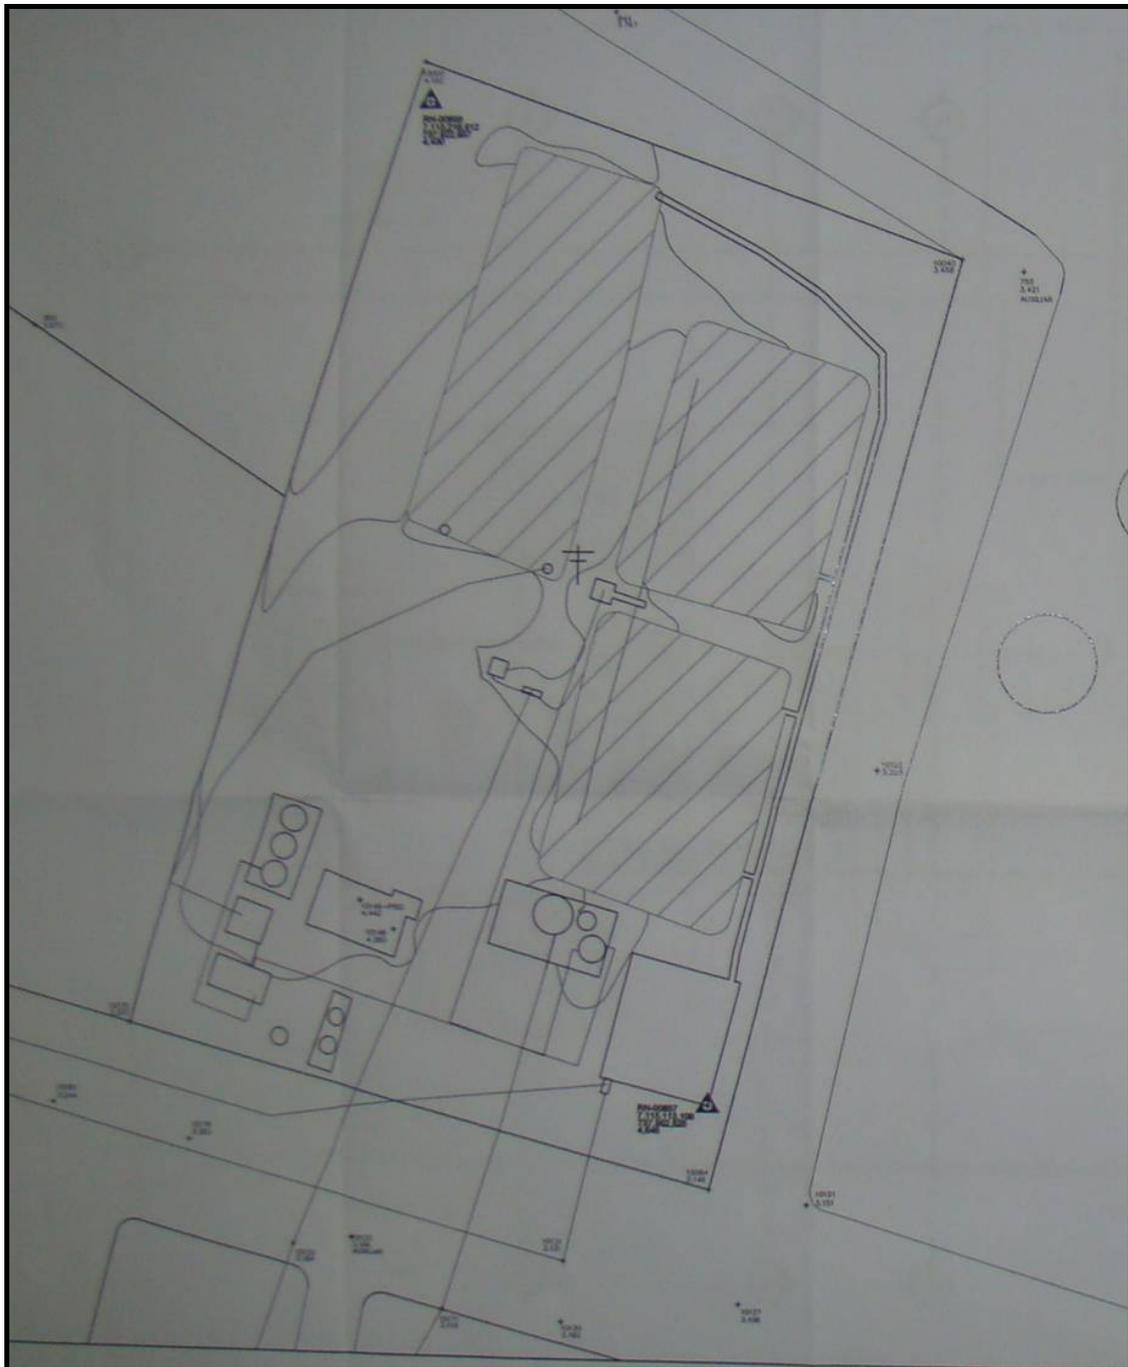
Planta Baixa – Lay-out da Estação de Tratamento de Água
